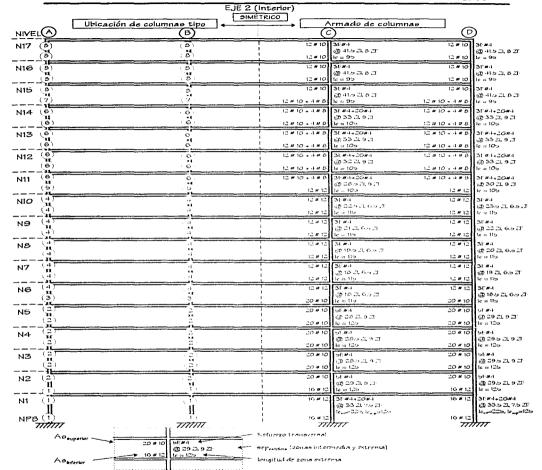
Ubicación de los tipos de armados de las columnas del eje 2 de la estructura de 17 niveles discriada en la zona lil
